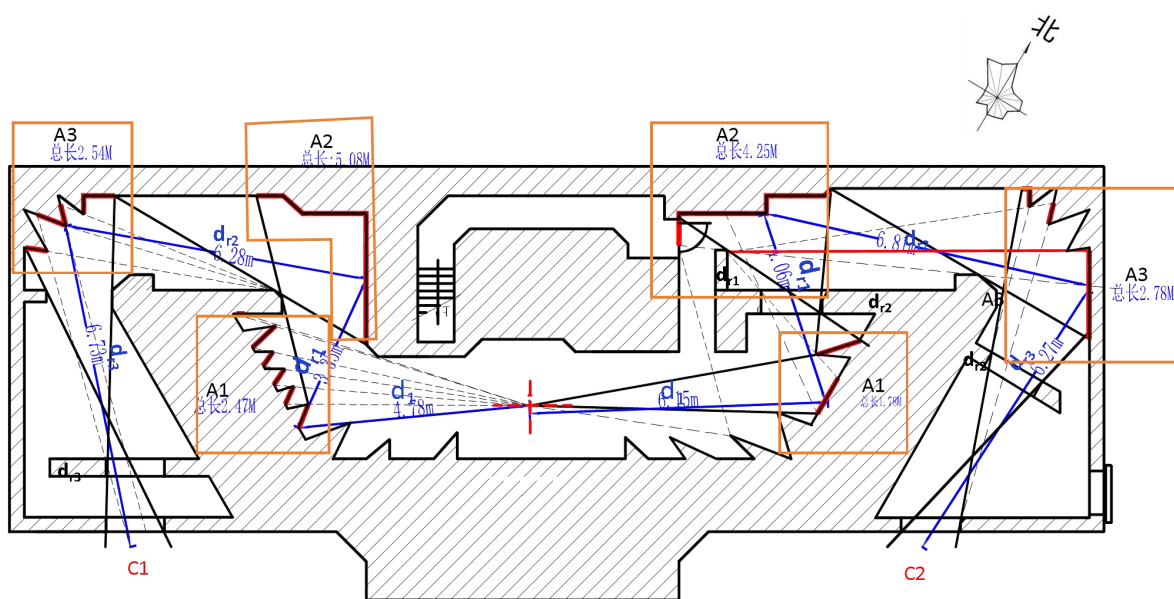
(1) 辐照室散射路径示意图 (平面图)
